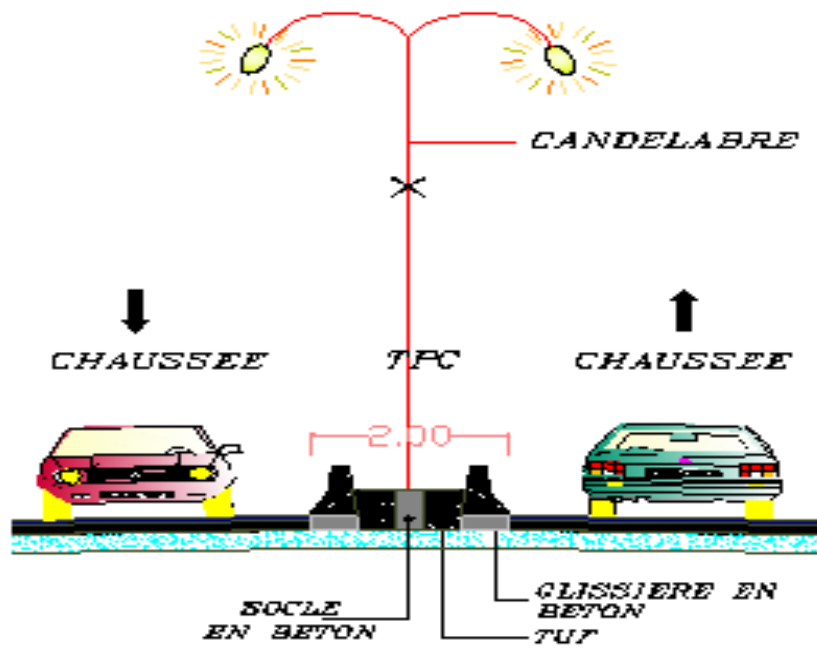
Coupe transversale et disposition de l'éclairage public
